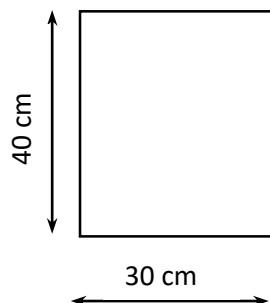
Pré-dimensionnement de la poutre palière N 01 (les escaliers d'entrée)
